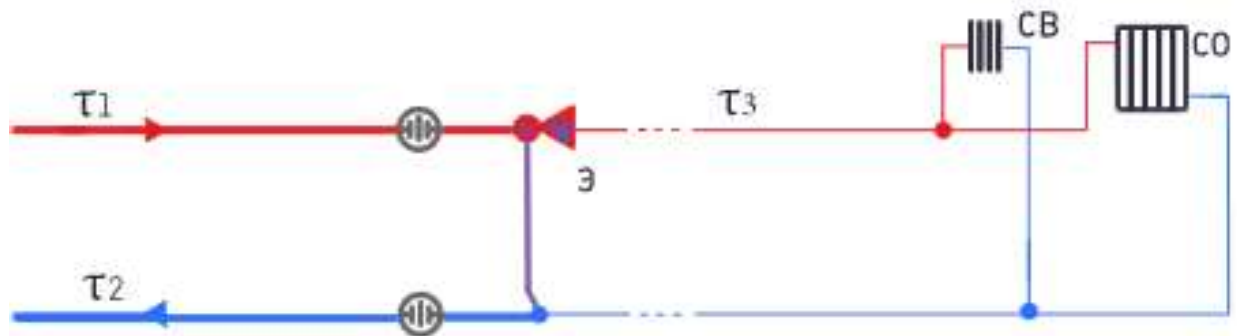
ЦТП с элеваторным присоединением СО и СВ
